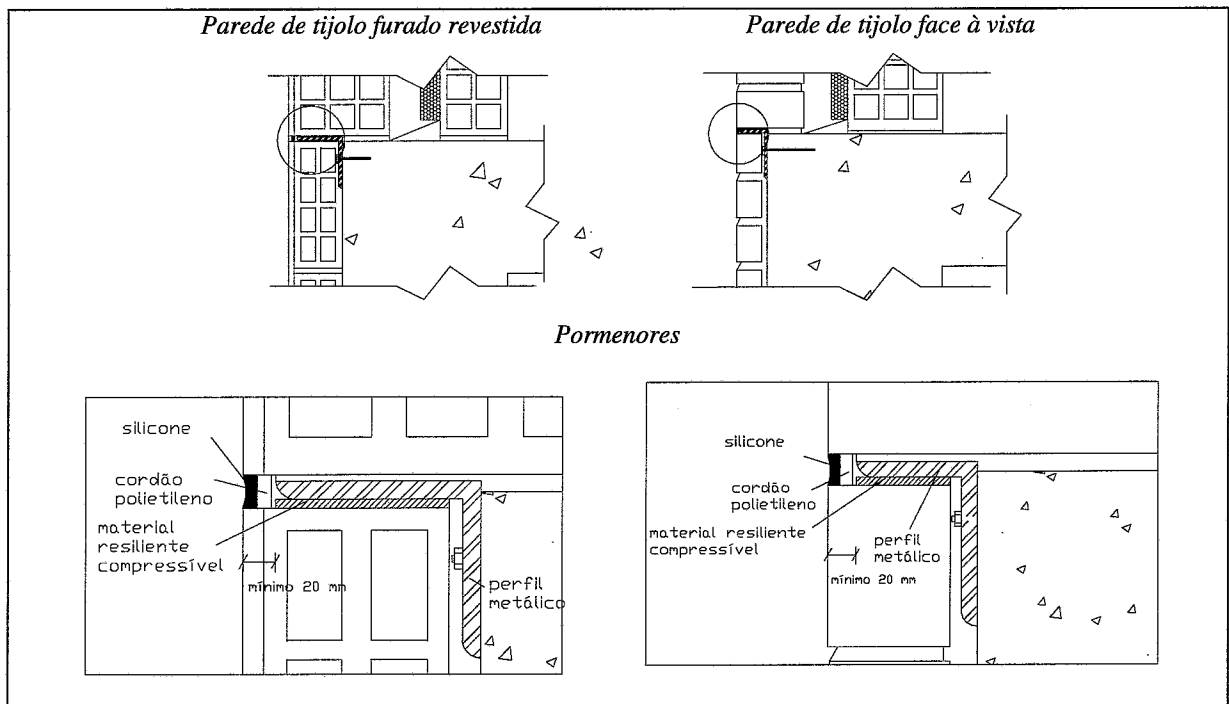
Pormenor de colocação de apoio metálico em zona de topo de laje para suprir a insuficiência de apoio
